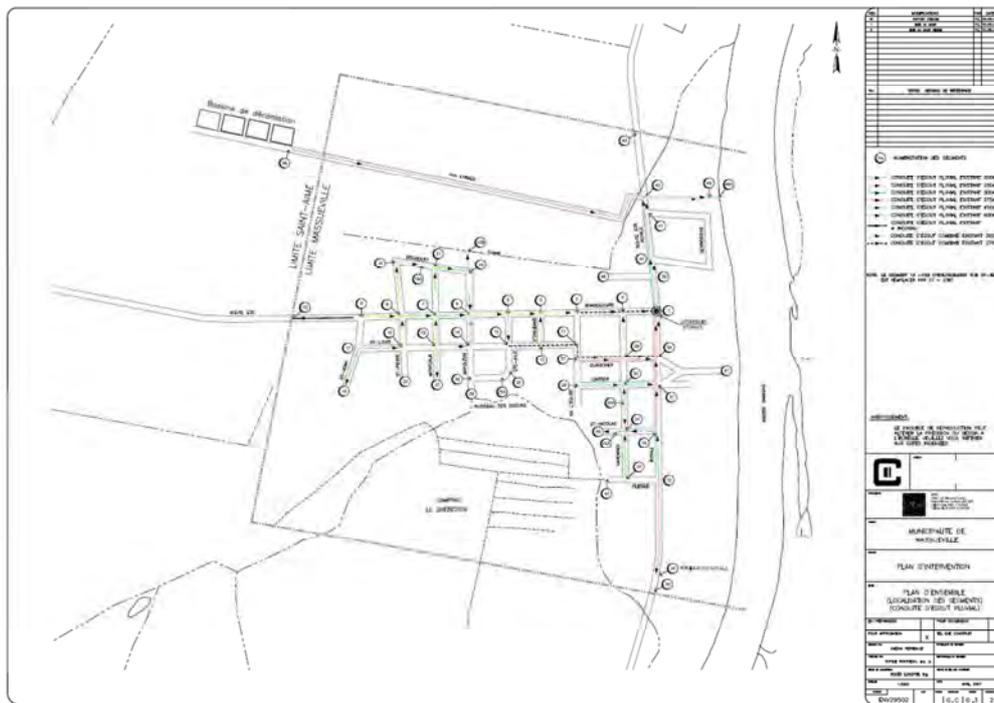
Localisation des segments - Conduite d'égouts pluviaux
